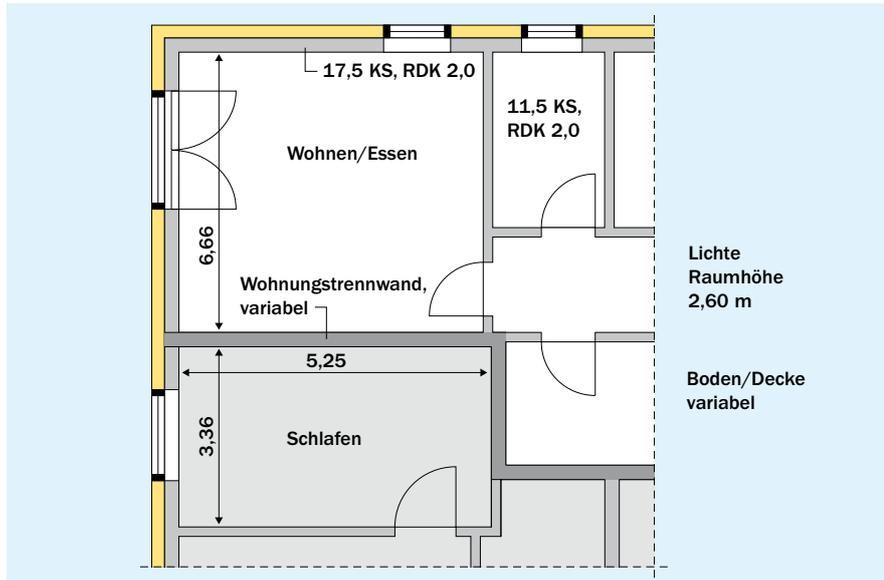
Ausschnitt Grundriss eines Mehrfamilien-Wohnhauses
